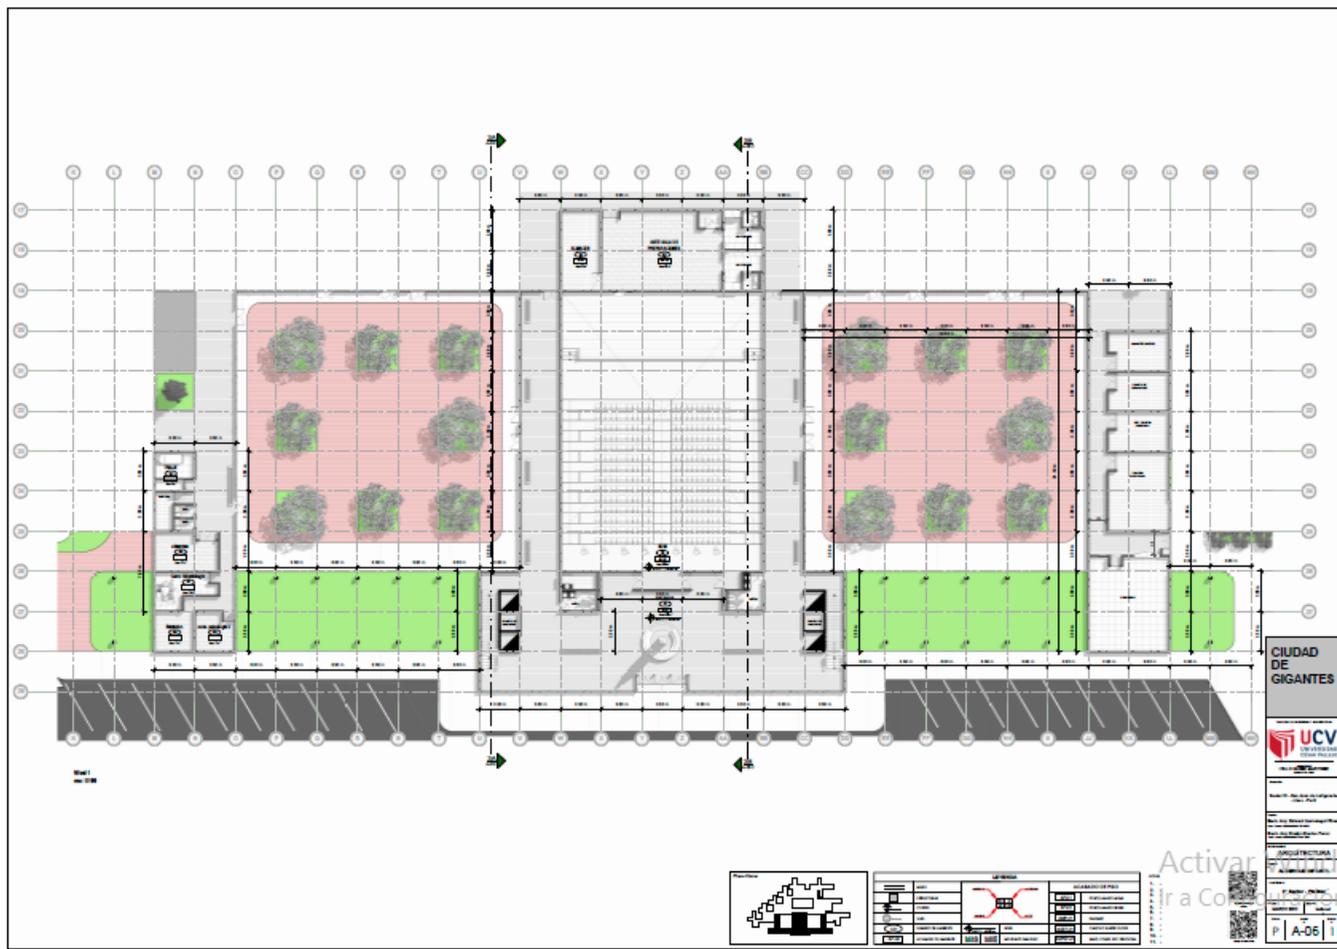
Plano de Planta Sector Servicios Complementarios - Primer Nivel
